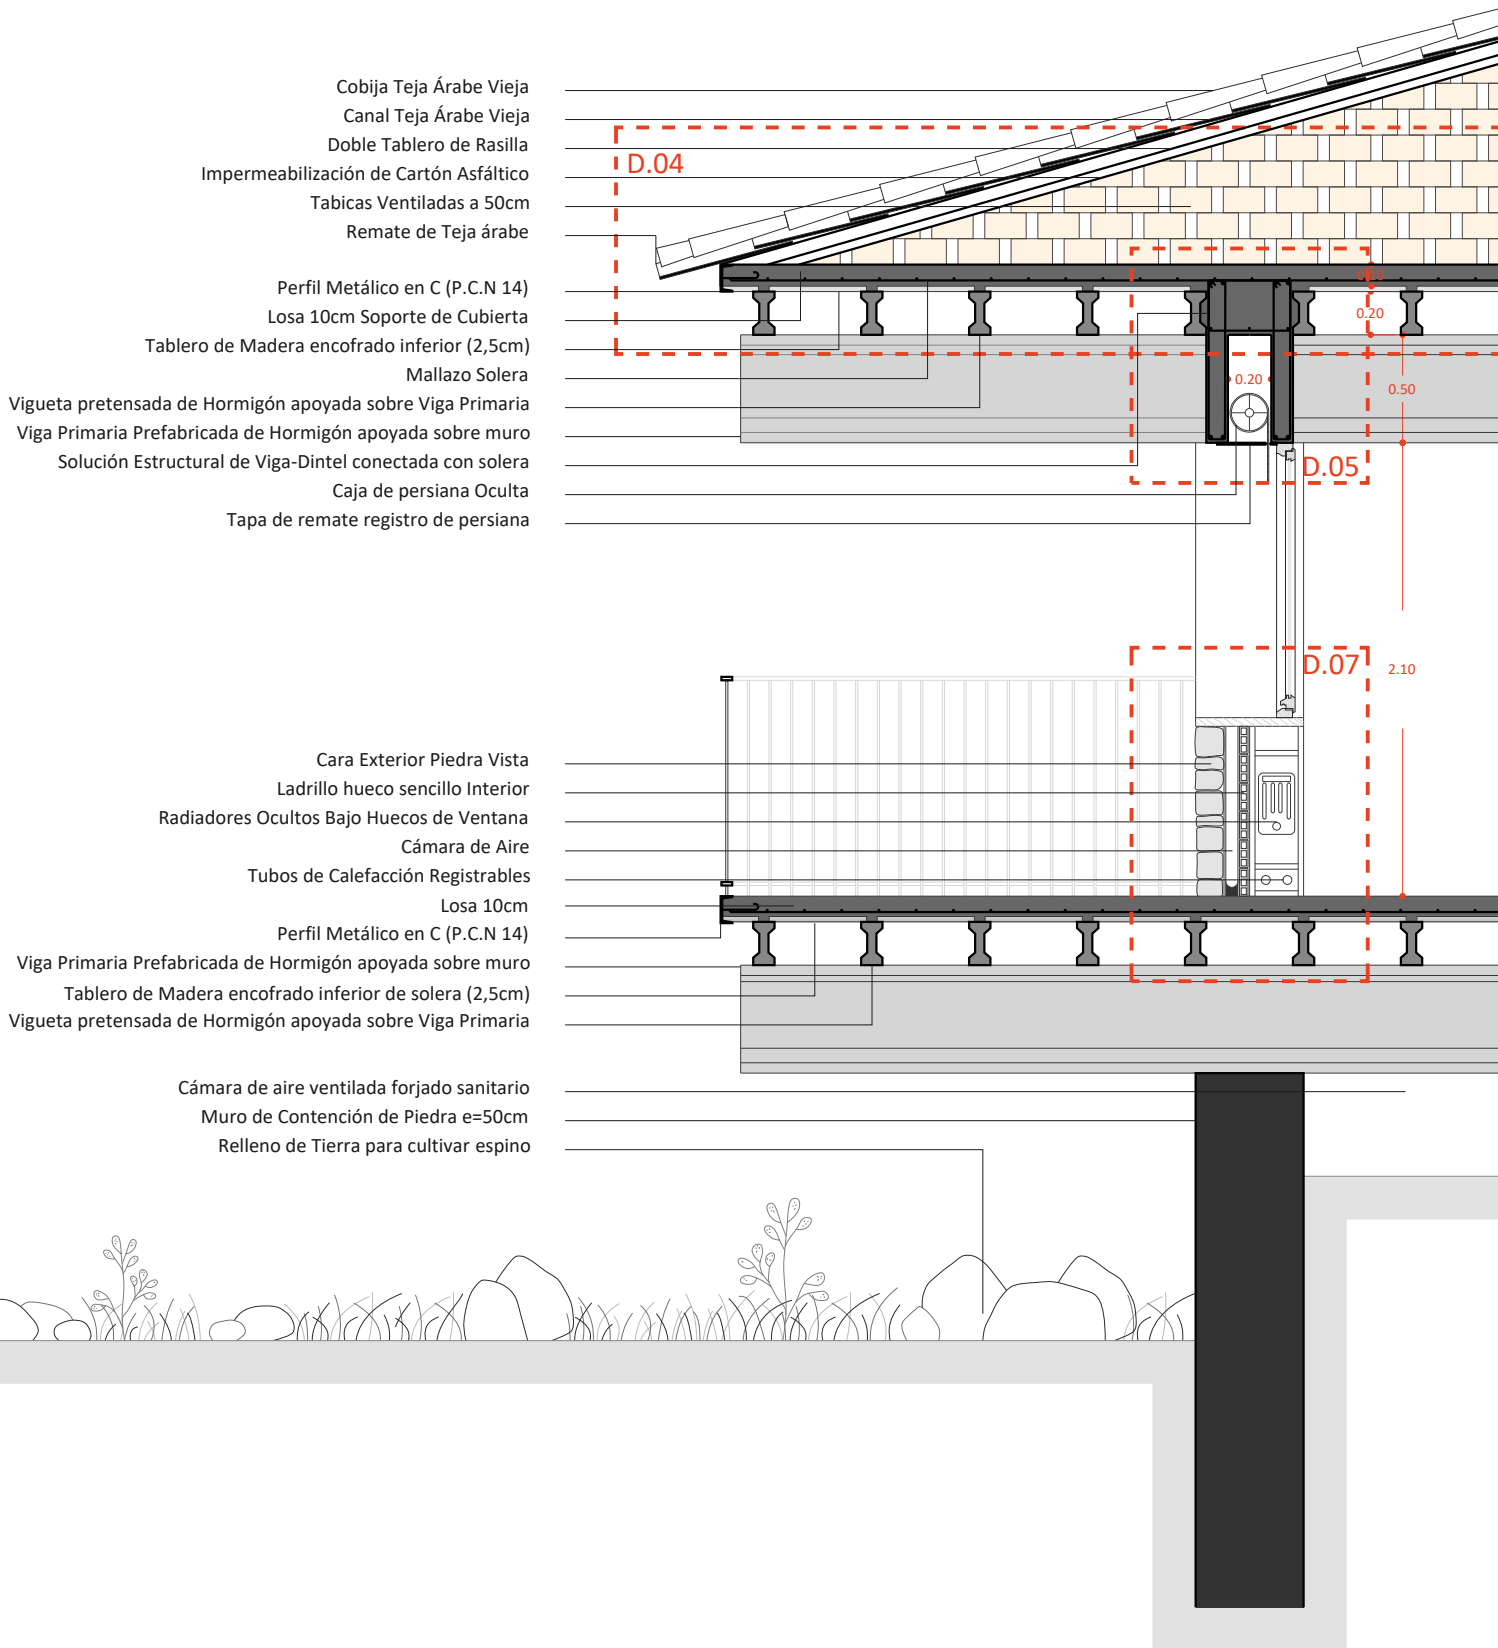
Detalle constructivo Casa Lucio Muñoz, estado original. Elaboración propia.
